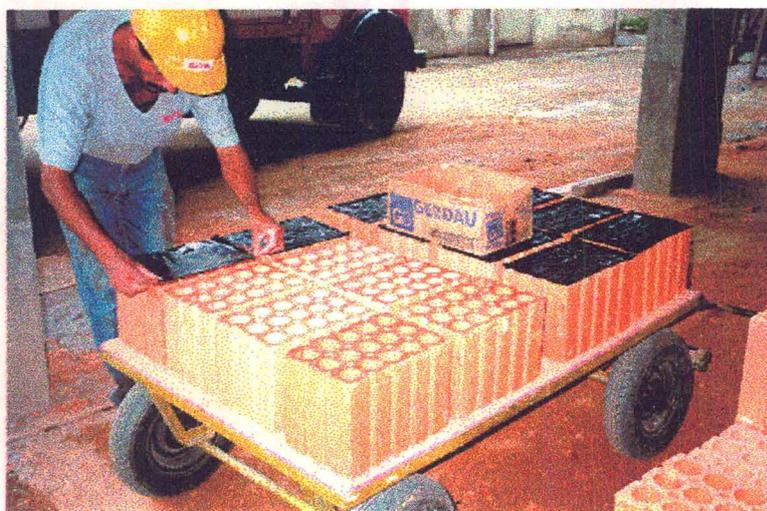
Vedação dos tijolos cerâmicos para utilização na confecção da laje nervurada
